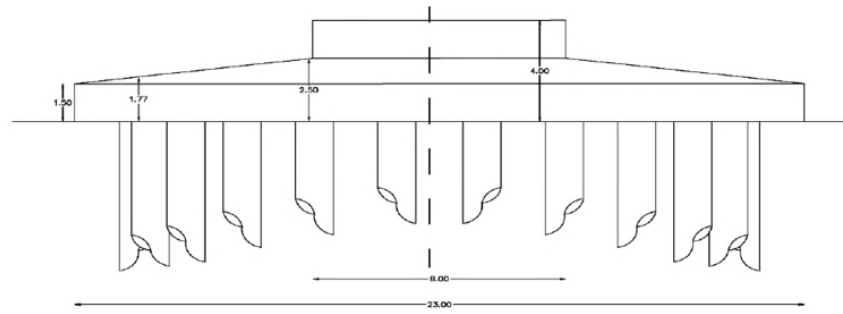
Pianta e prospetto della fondazione dell'aerogeneratore
